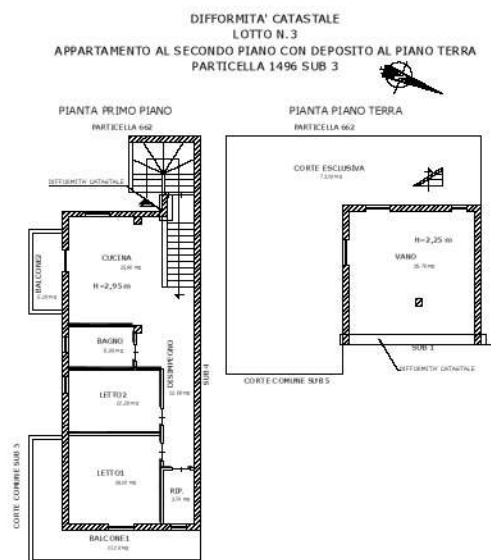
Planimetria delle difformità catastali del Lotto N.3
